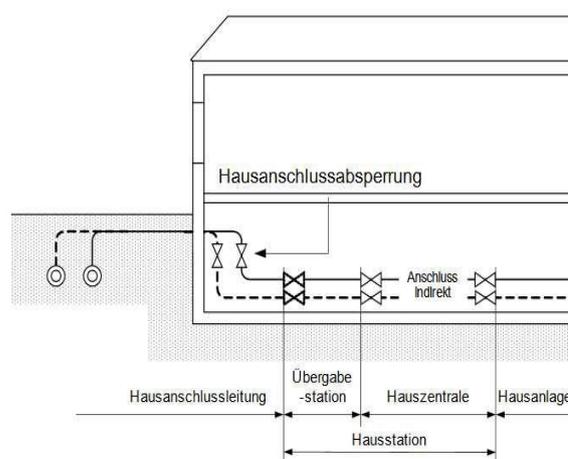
Hausanschlussleitung und Hausstation nach AGFW FW 515
